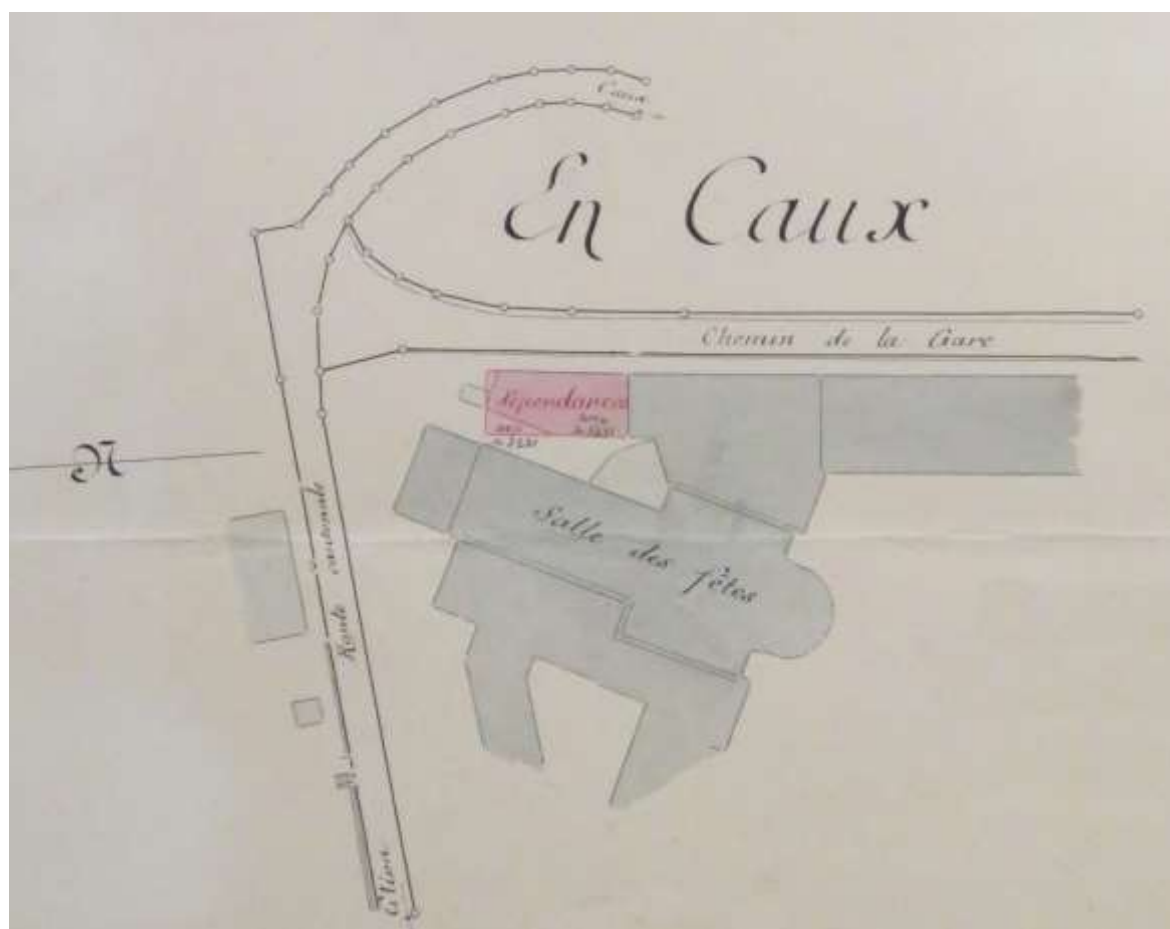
Plan de situation, agrandissement du promenoir, 1908, Louis Maillard architecte (AM, CER-GE-218).
